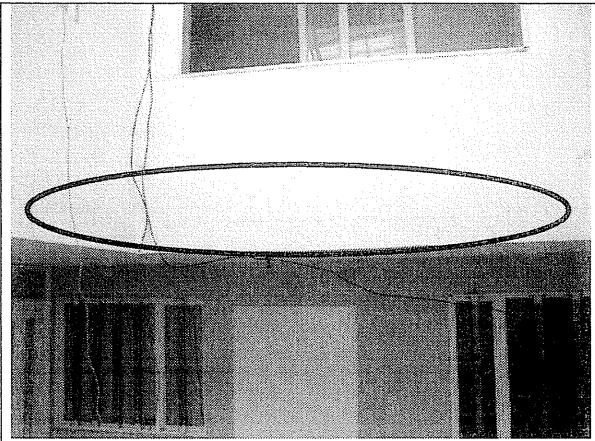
Fisura en la junta muro placa de entrepiso.
